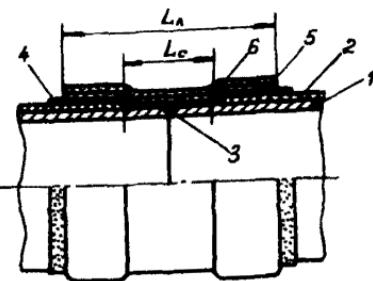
Изоляционное покрытие зоны сварного стыка полимерными лентами при $L_A \geq L_c + 15$ см:
